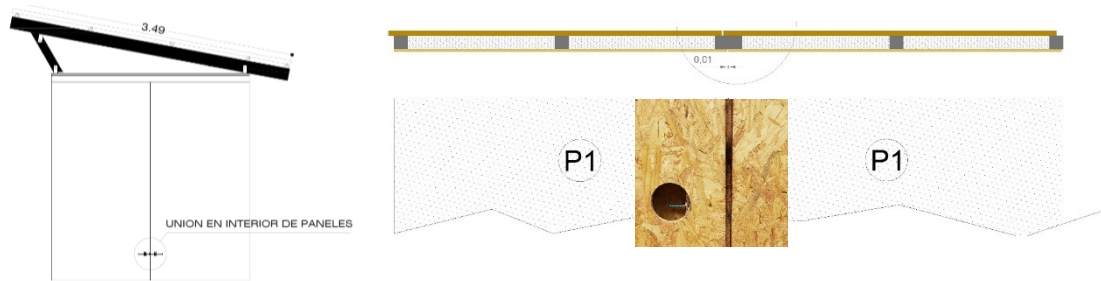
Anclaje entre paneles y detalles constructivos de juntas de dilatación
